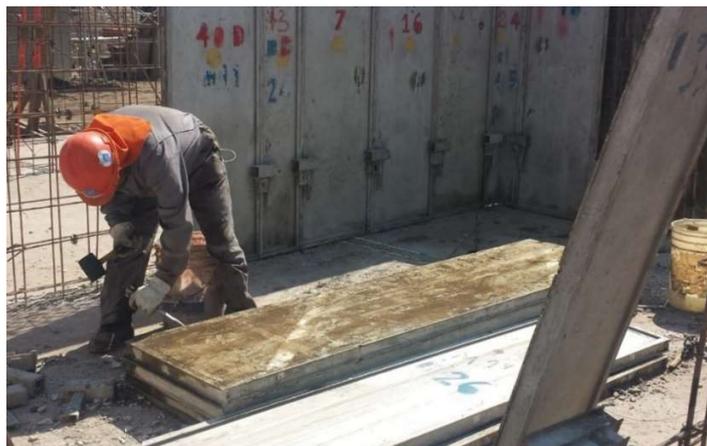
Tarea de Limpieza de Piezas de Moldaje por Maestro de Primera.
